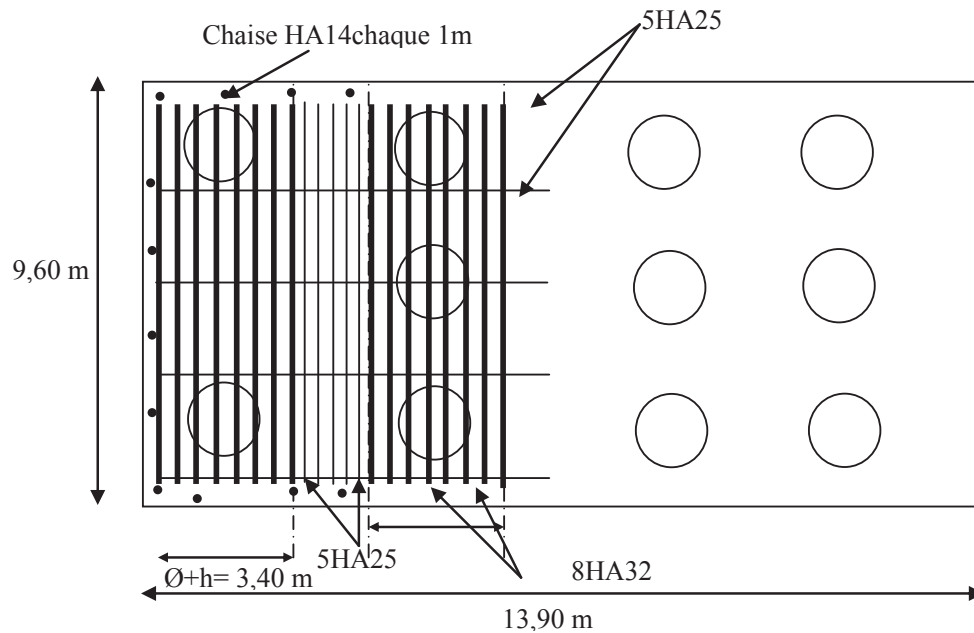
Ferrailage de la semelle (nappe inférieure) .
